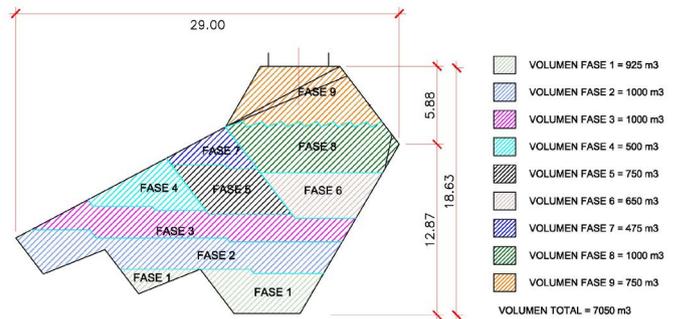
Fases de hormigonado de la cimentación norte del arco.
